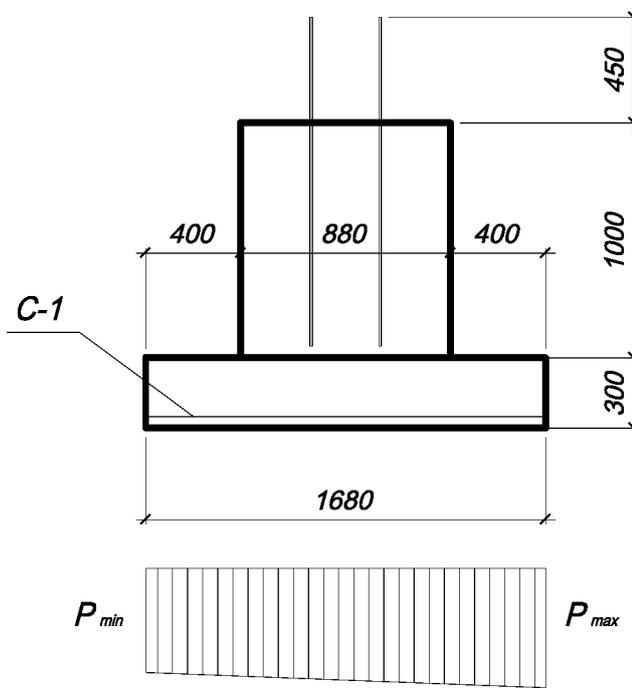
До визначення перерізу арматури плитної частини фундаменту
